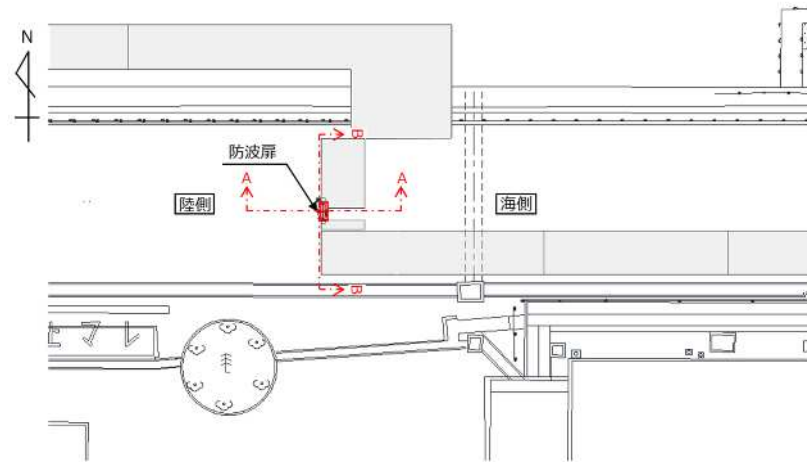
(1) 防波壁通路防波扉（2号機北側） 平面图
